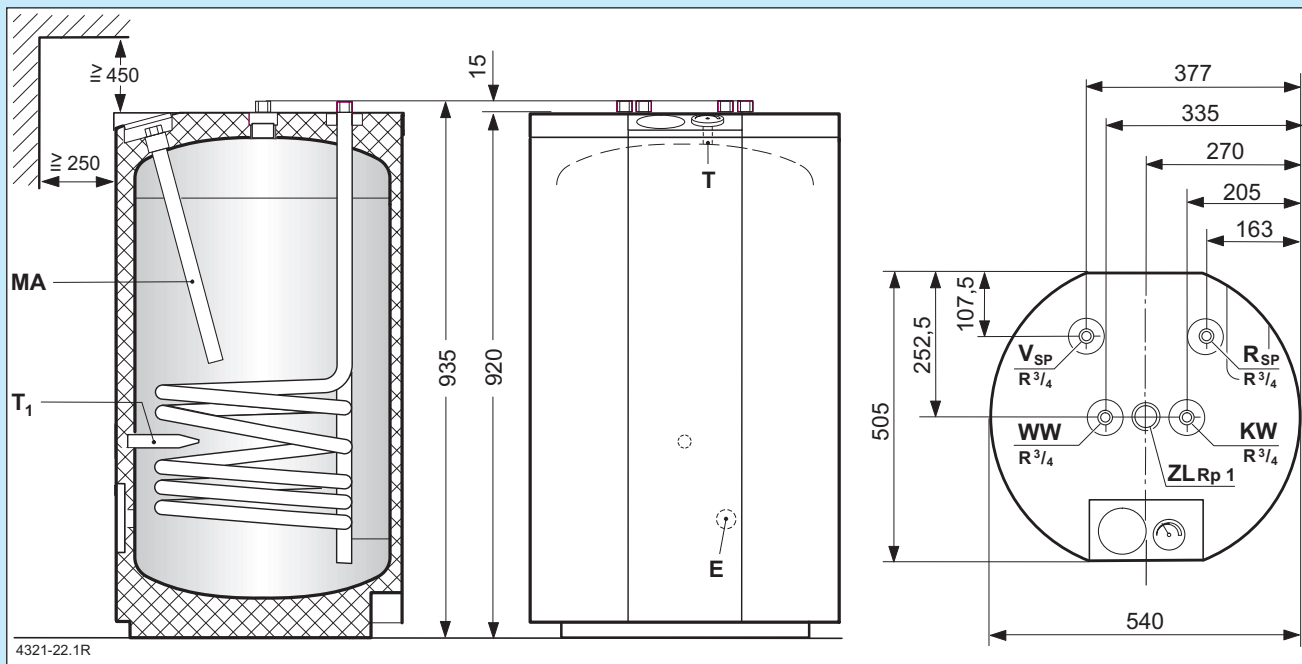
Bau- und Anschlussmaße ST 120-1 Z
